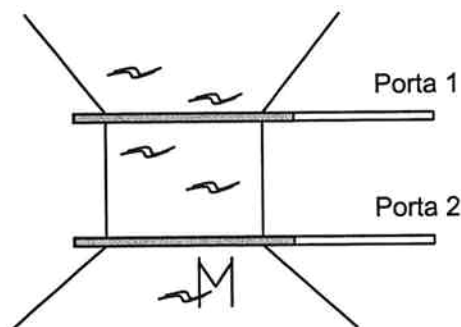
SCHEMA PLANIMETRICO DELLA CONCA CON LE PORTE CHIUSE (ASSUNTO NELLA DESCRIZIONE)
